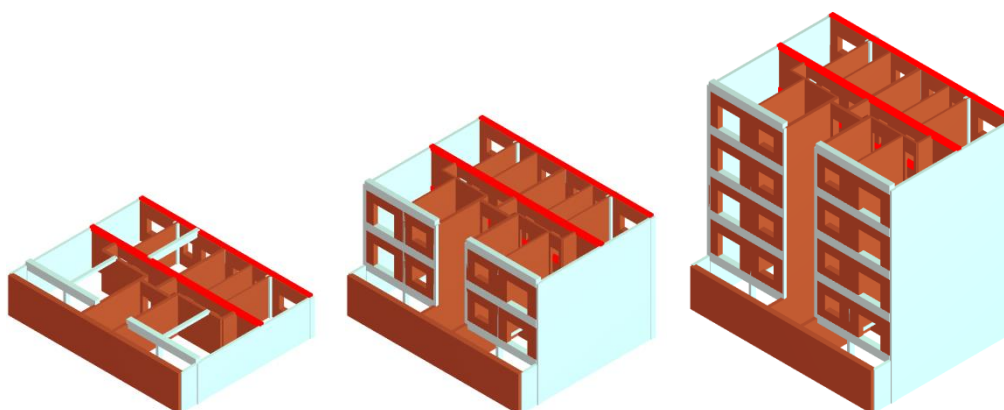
Esquema de introdução da viga de contraventamento ao nível do pavimento de cada piso em uma parede interior segundo a direção X, e do reforço das vigas da fachada de tardo com fibra de carbono, rés-do-chão (esq.), 2º piso (meio) e cobertura (dirt.).
